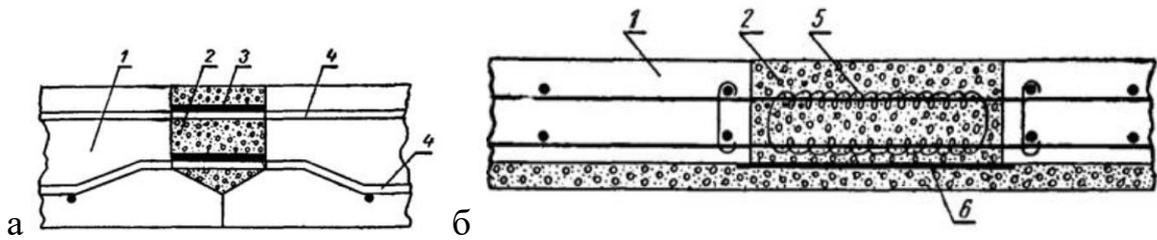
Замоноличенный шов: а – поперечный разрез; б – план; 1 - железобетонная плита; 2 - заполнение бетоном; 3 - сварка; 4 - рабочая арматура; 5 - сварка или обмотка вязальной проволокой; 6 - прокладка из рубероида
